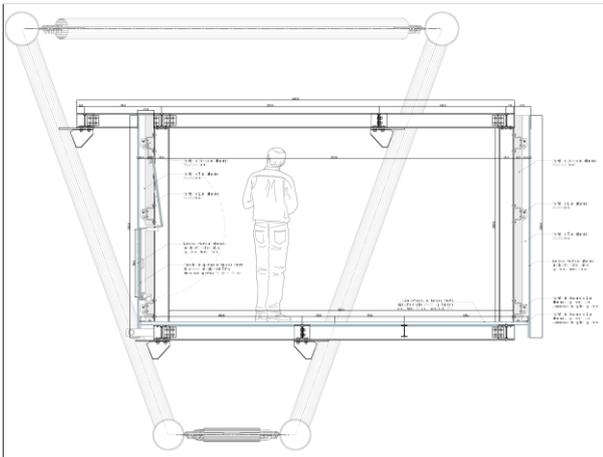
Sezione trasversale e Concio di trave della struttura secondaria
